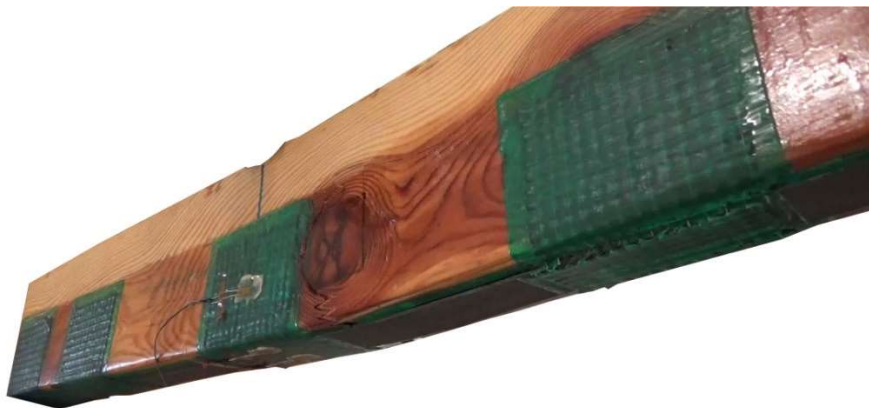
Fotografía de la rotura por tracción de la viga BR-B-3.
